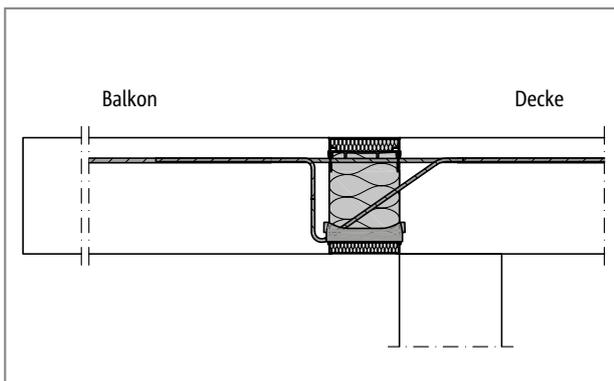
Schöck Isokorb® Typ KXT ohne Brandschutz
